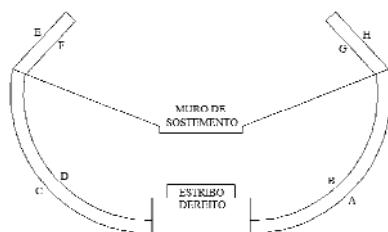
Planta da defensa existente entre o estribo derecho e o muro de sostemento
